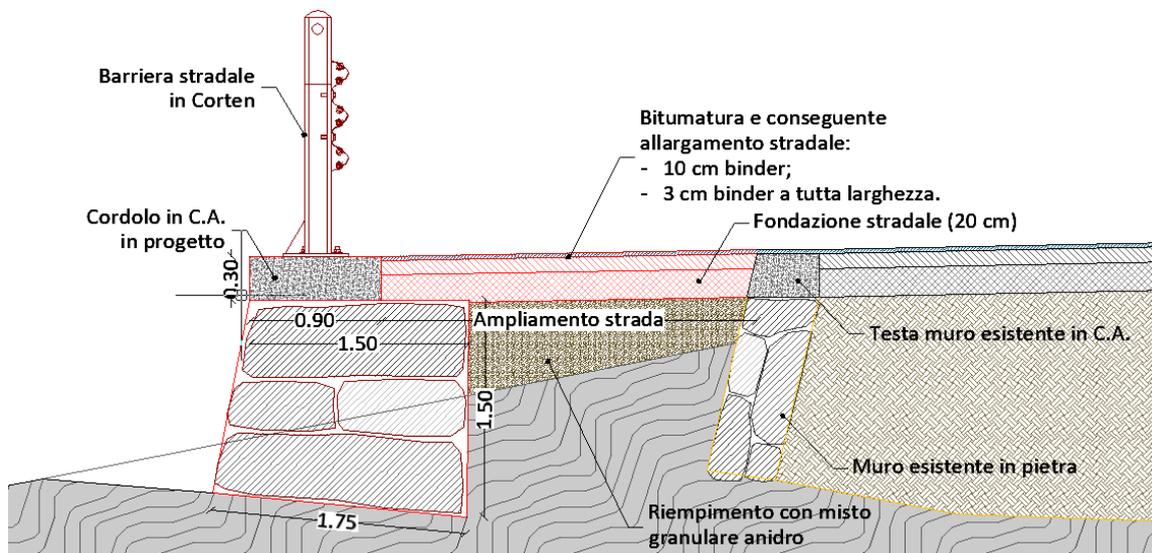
Sezione tratto stradale ampliato con sottomurazione
